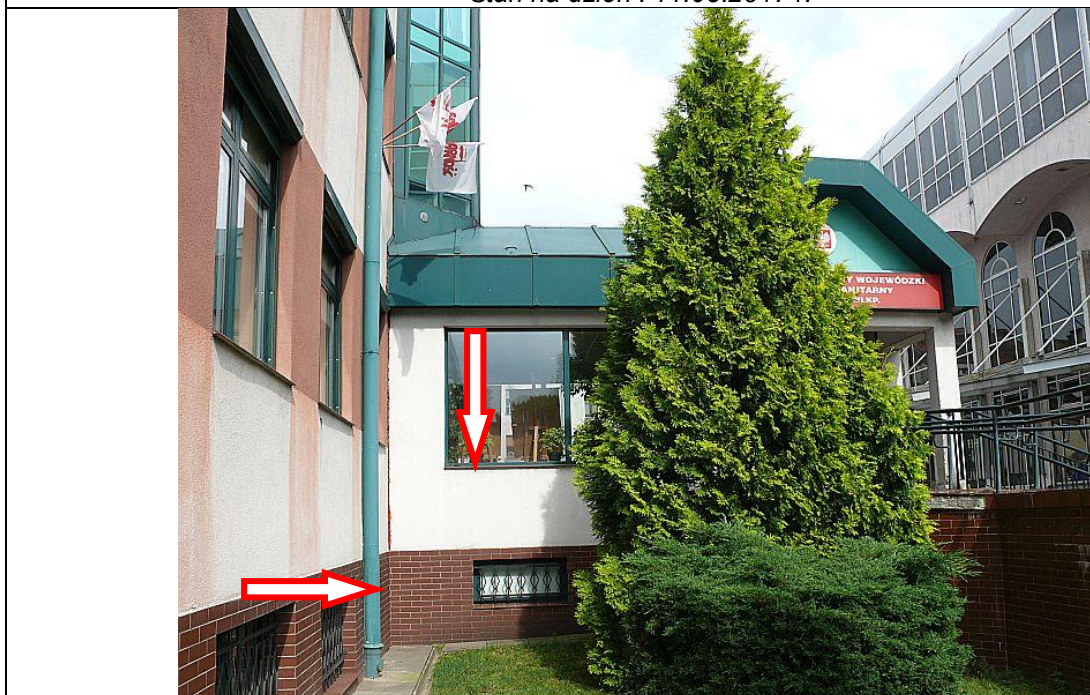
Elewacja zachodnia ganku budynku.
